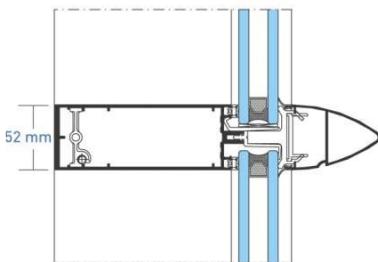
Sobre estas líneas y a la derecha: Muro cortina stick con tapetas horizontales y silicona estructural vertical.
